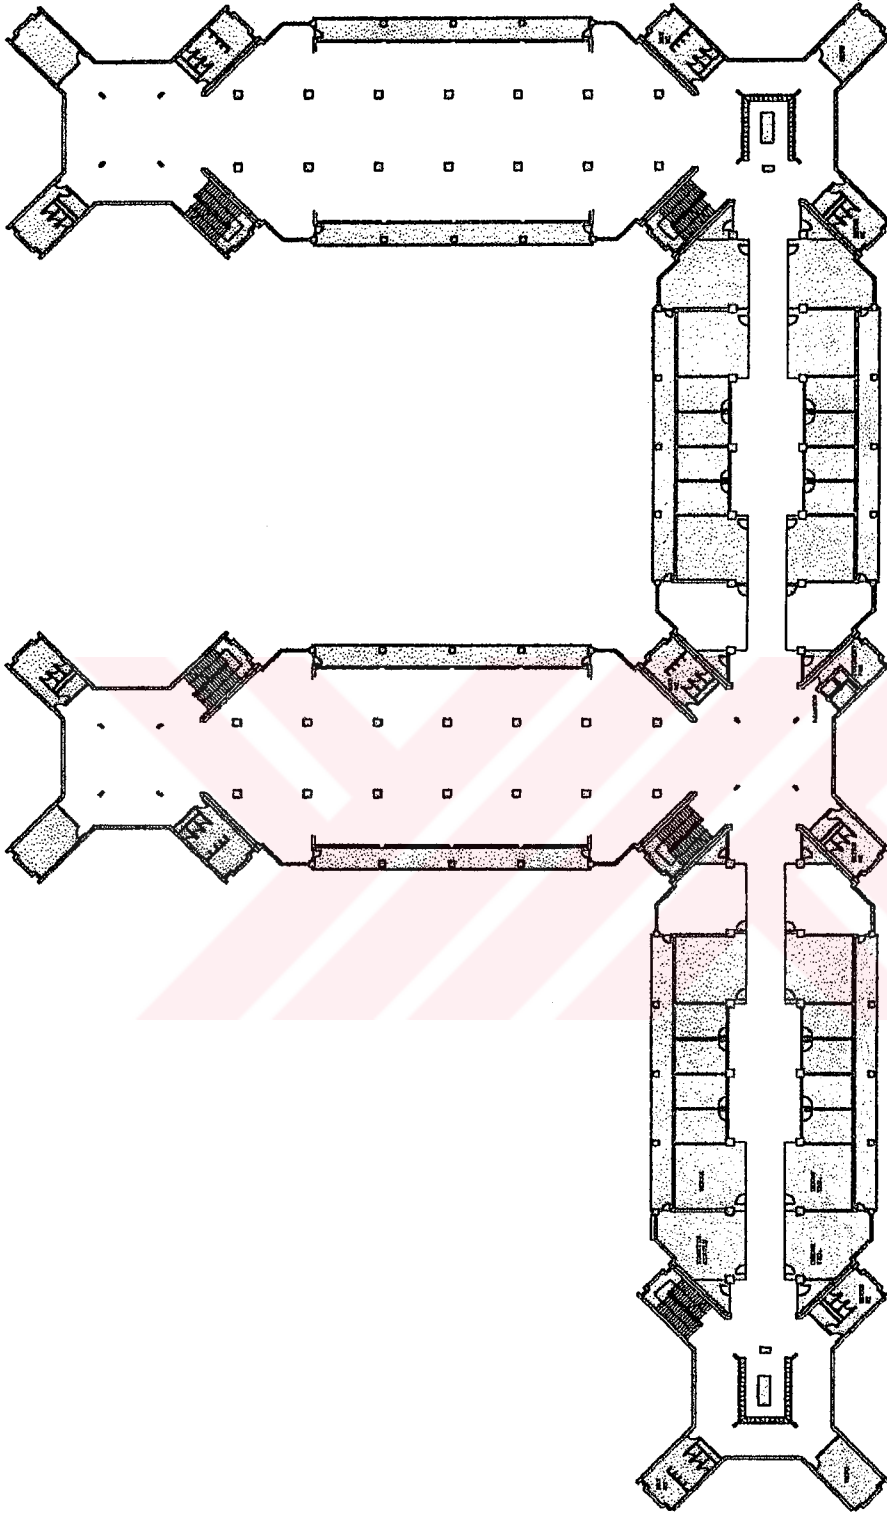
a: D.Ü. Kampusu Tıp Blok Planı Bodrum Kat Planı
